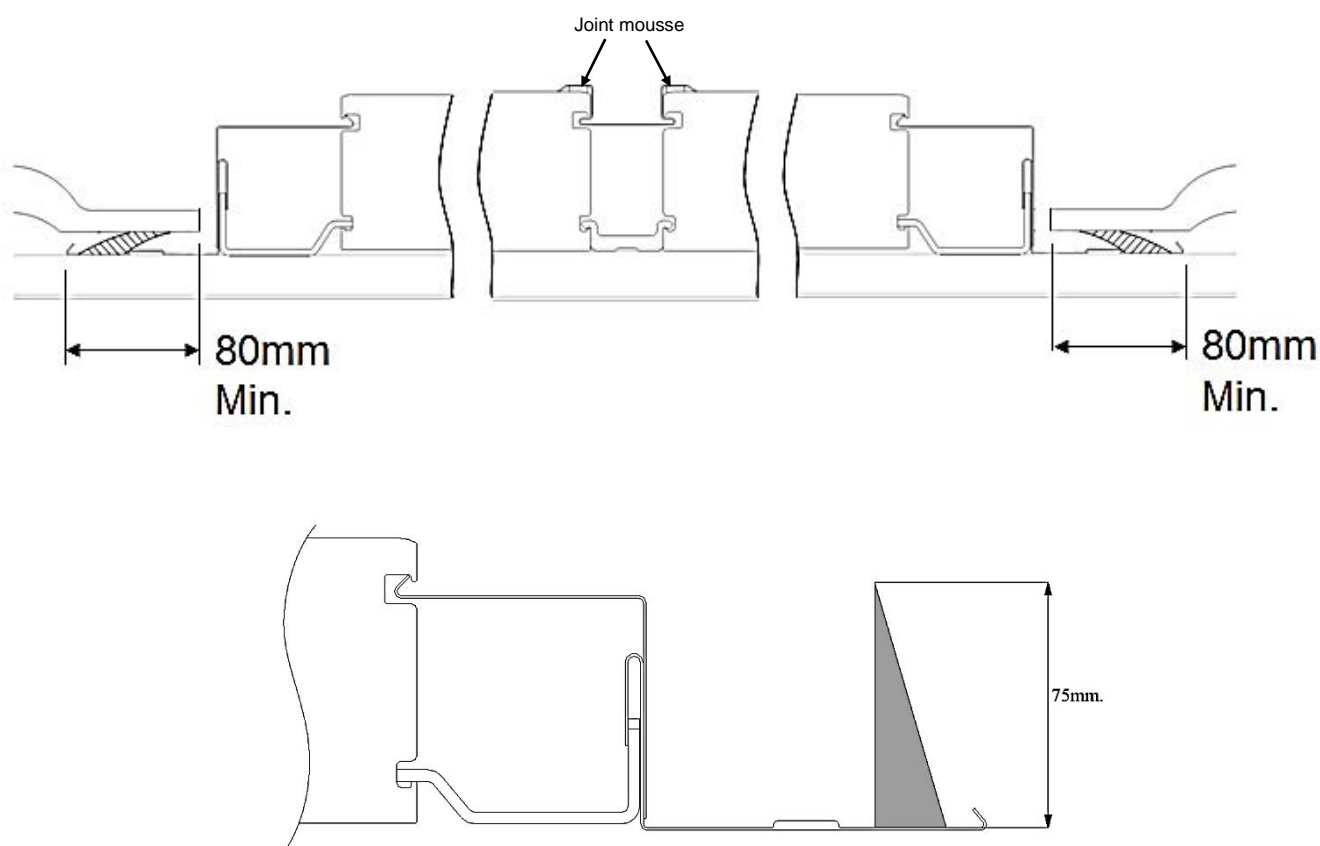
Détails du raccordement intercapteur et recouvrements latéraux minimum.
